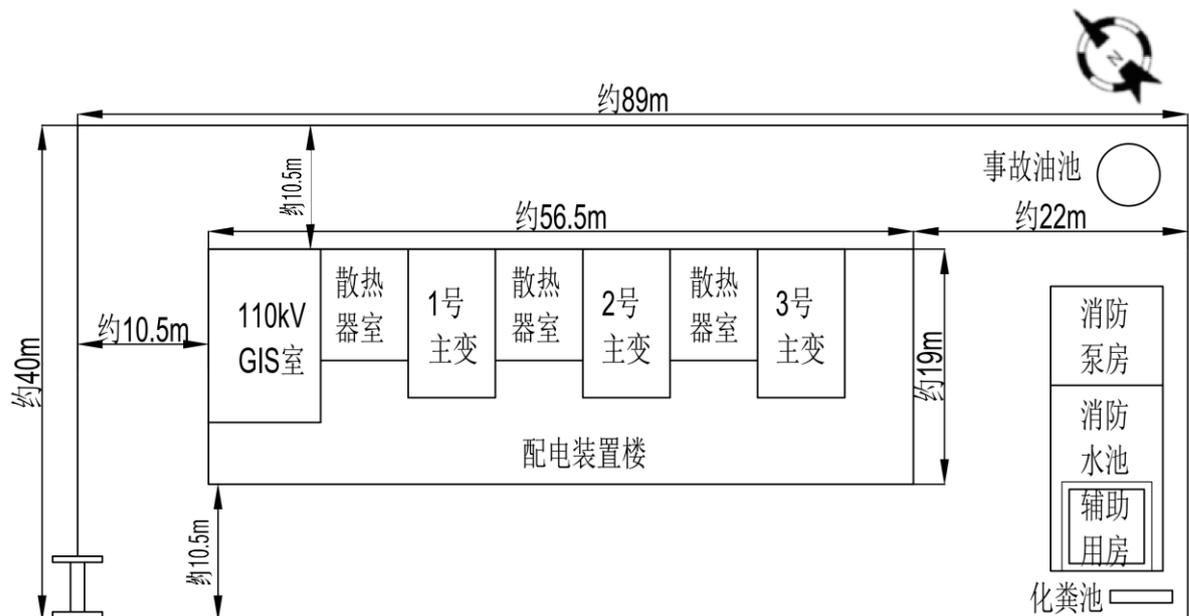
新建院士谷 110kV 变电站平面布置示意图
